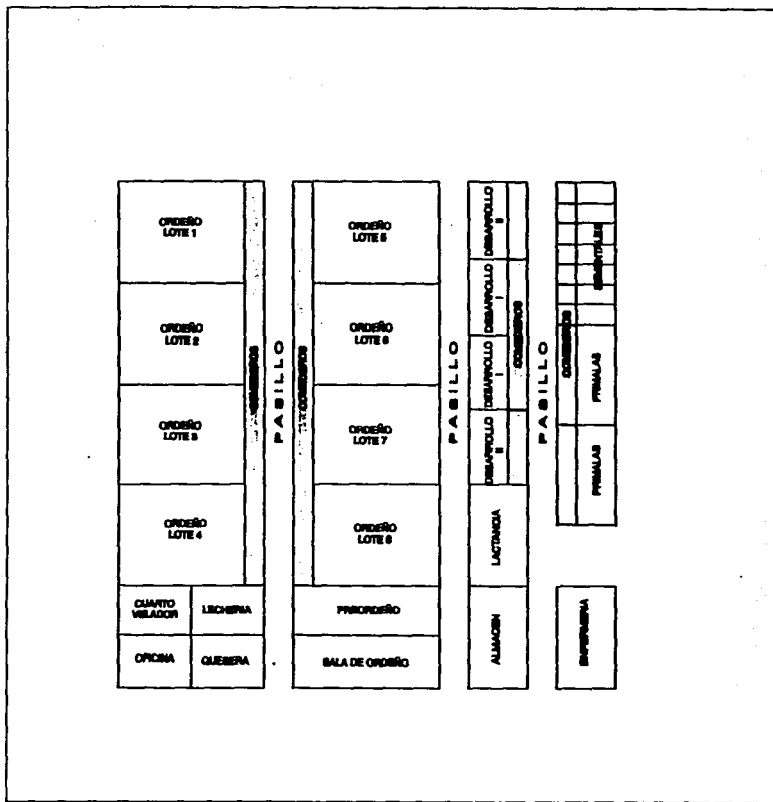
CROQUIS DE LAS CONSTRUCCIONES DEL PROYECTO
